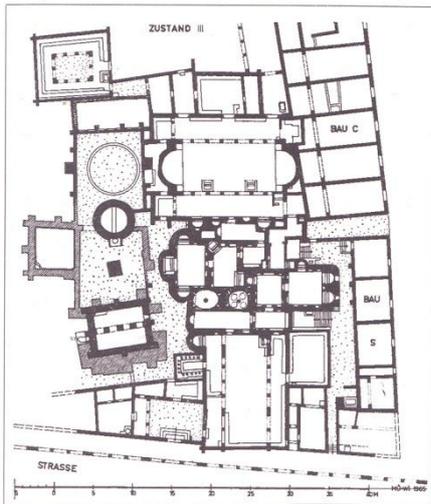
Grundriss des Menasbades (Rekonstruktion nach Müller-Wiener) [Kiby S.17]
